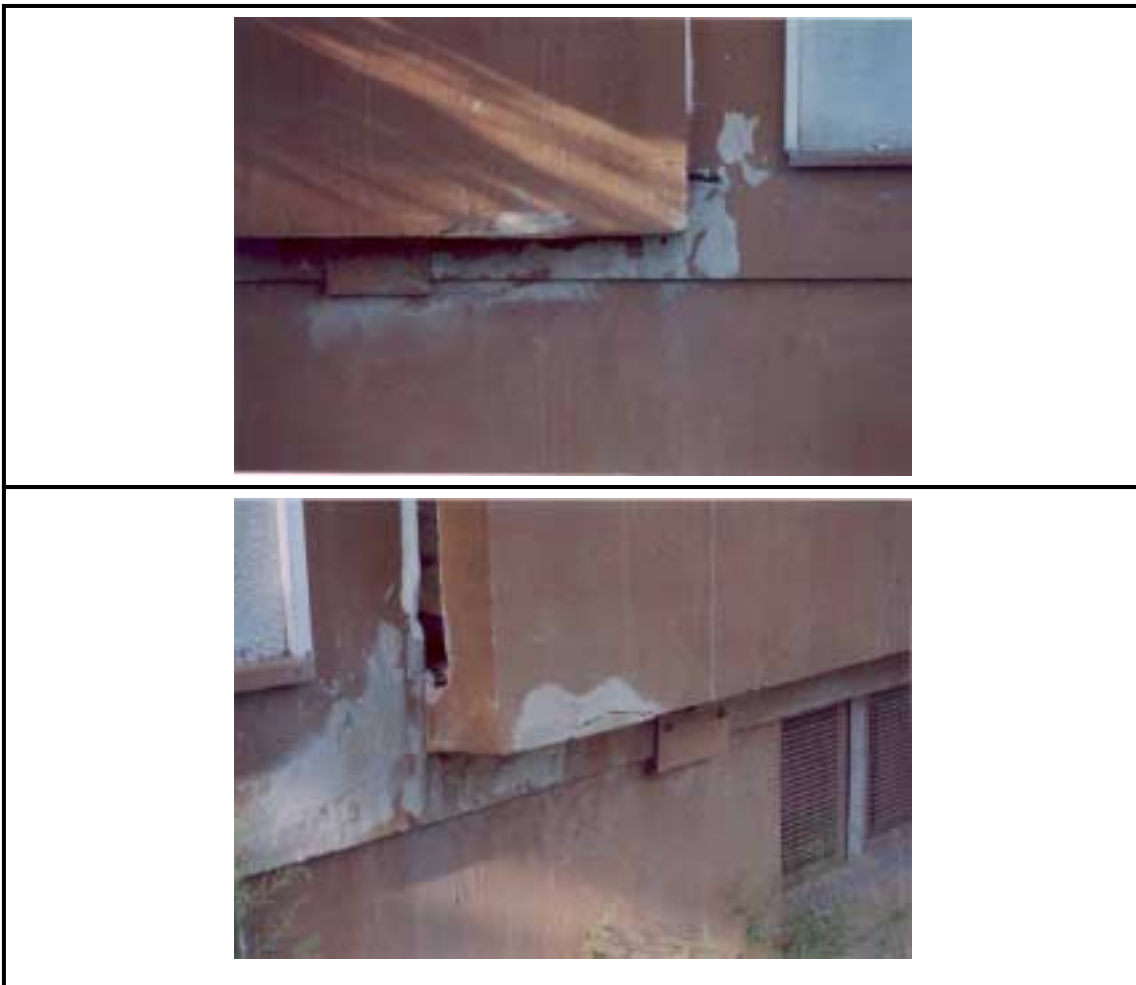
Fassaden und Balkonansicht der vorhandenen Bausubstanz
